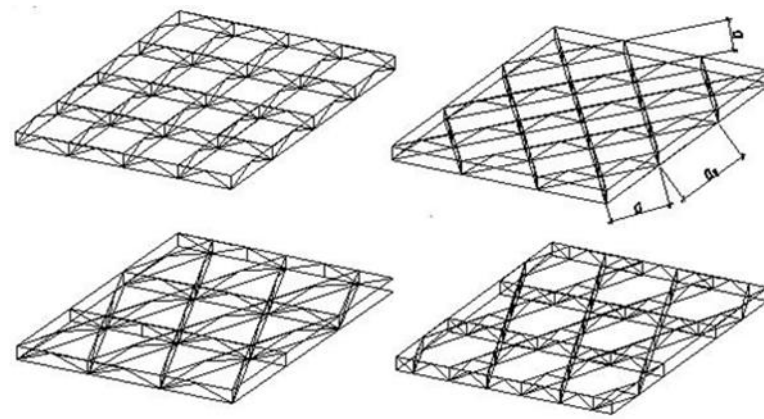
Показывает схемы перекрытий из вертикальных перекрёстных ферм.
